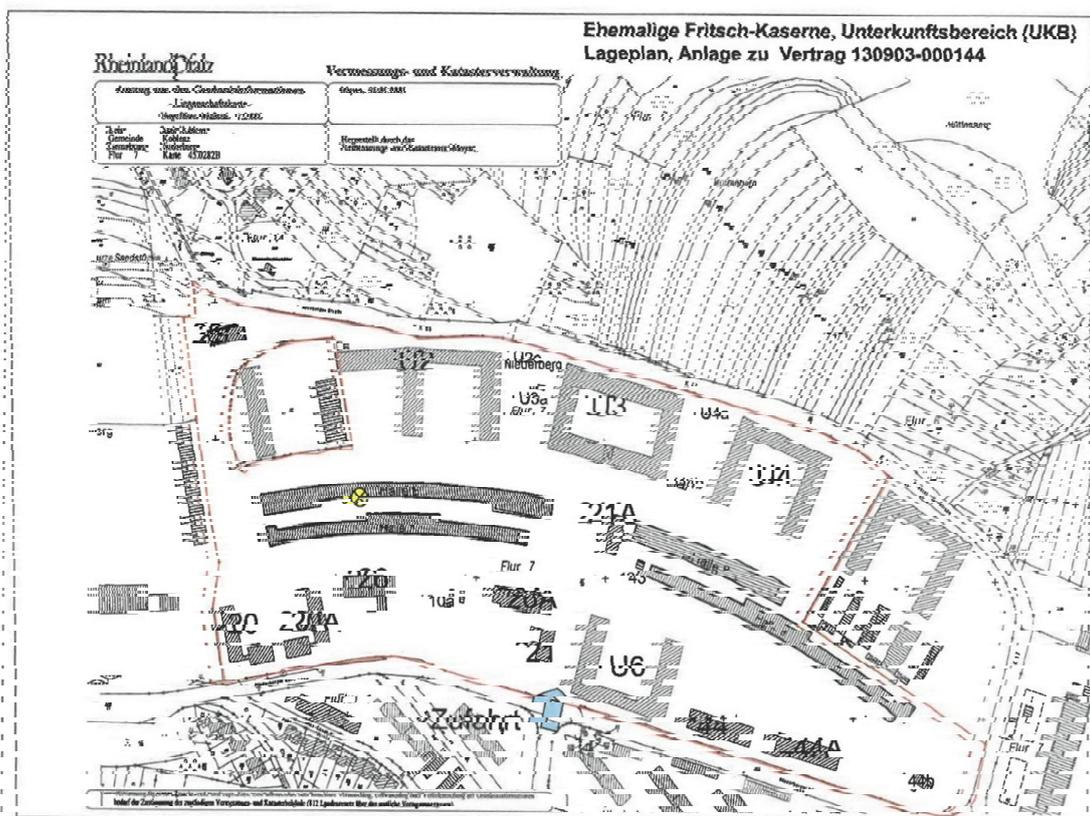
Lageplan Kaserne mit Gebäudenummerierung, Darstellung BPD
